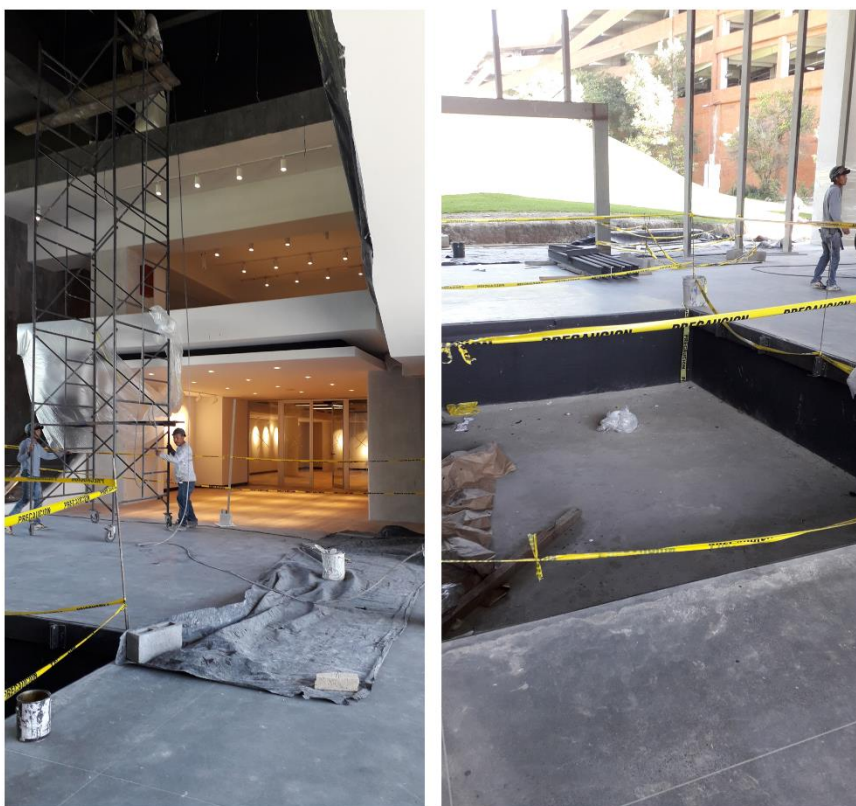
Vestíbulo Principal en construcción - Fotografía Propia
